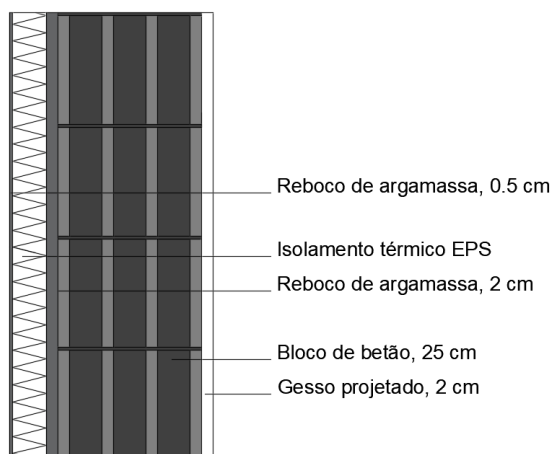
Pormenor construtivo base das paredes exteriores.
